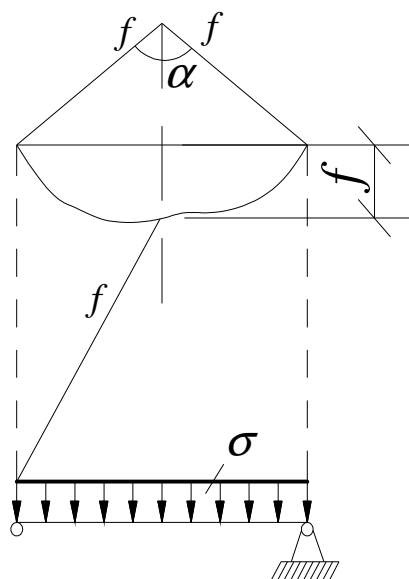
Расчетная схема прокладки газопровода водных преград
